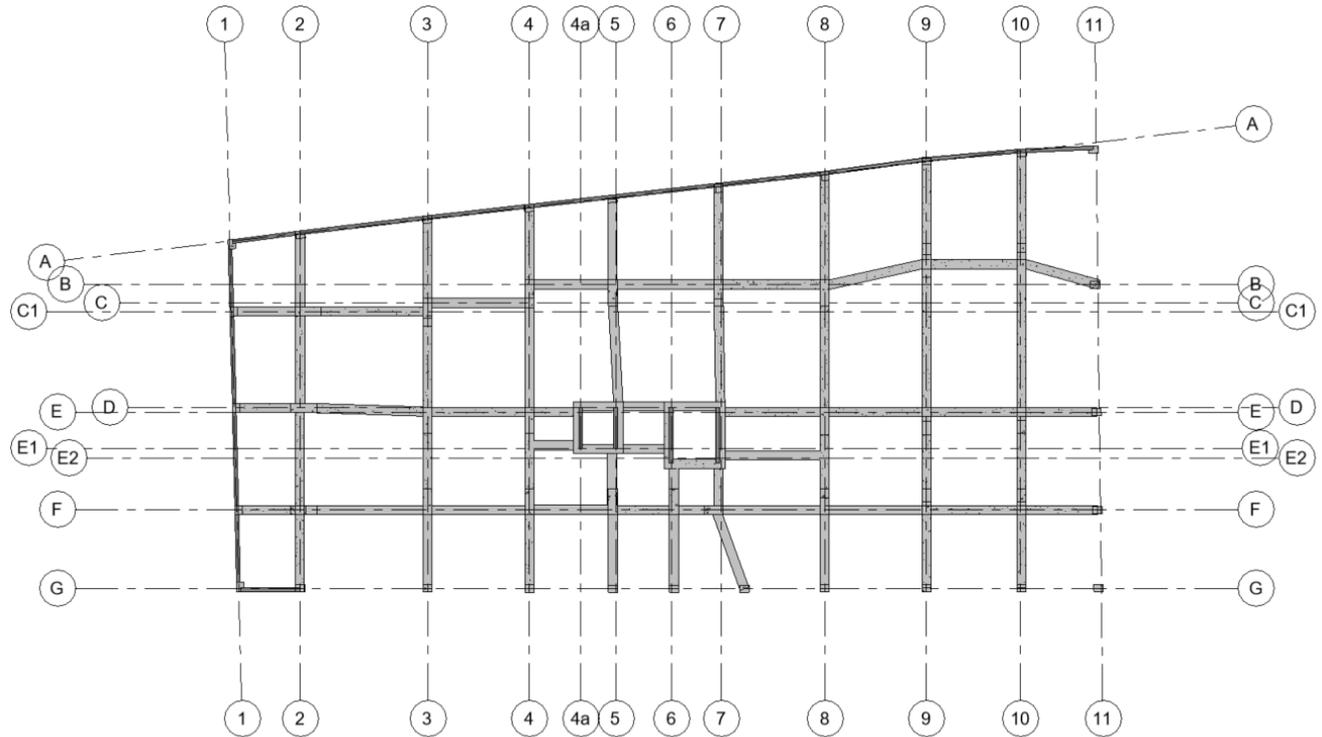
Modelado de losa Radier, vista en frontal, sótano 5.
